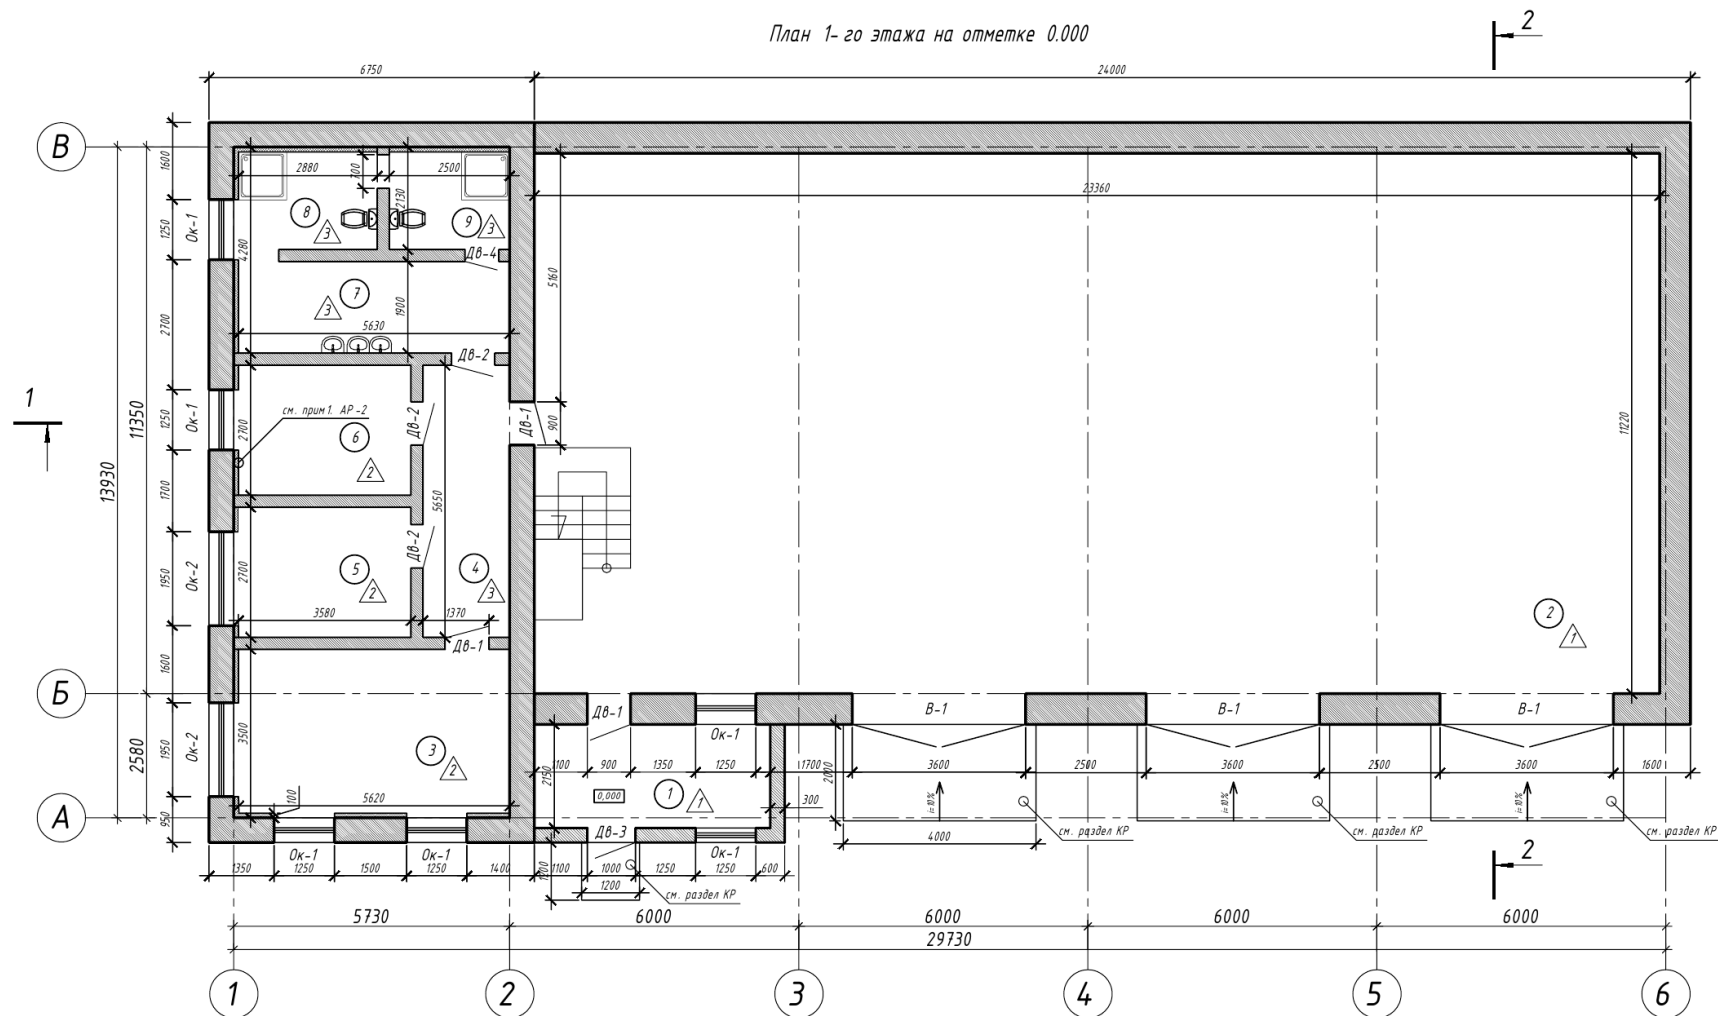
Схема планировки 1 этажа здания эллинга
